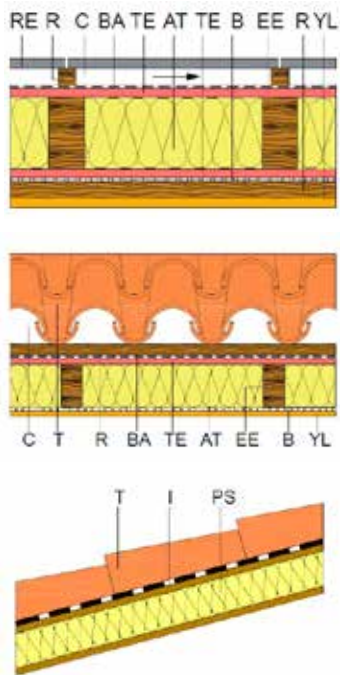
Ejemplos de fachada y cubiertas de madera del Catálogo de Elementos Constructivos (<https://itec.cat/cec/>).
